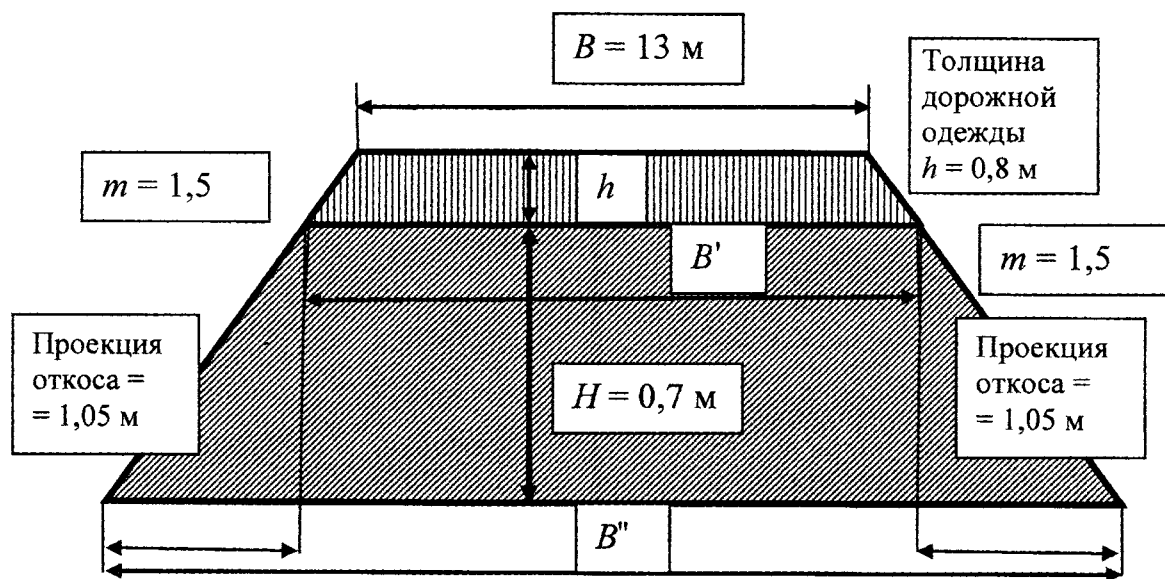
Расчетная схема подошвы дорожного полотна
